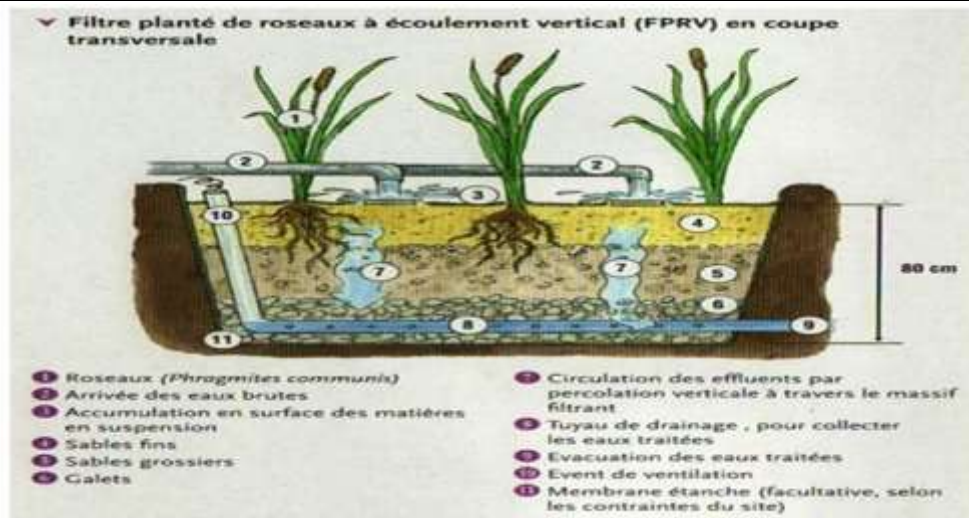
coupe transversale de filtre planté à écoulement vertical
